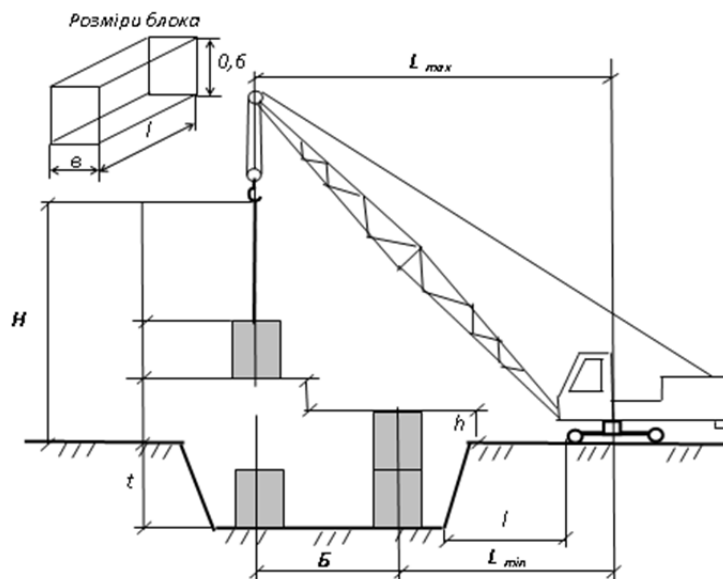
Розрахункова схема монтажу фундаментних блоків
